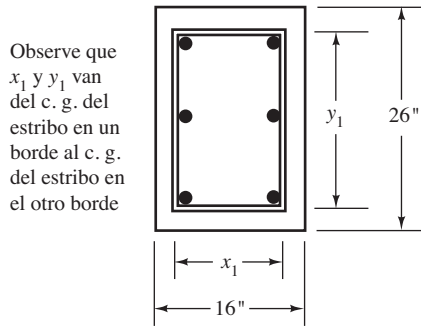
Sección transversal de la viga del Ejemplo 15.1.
